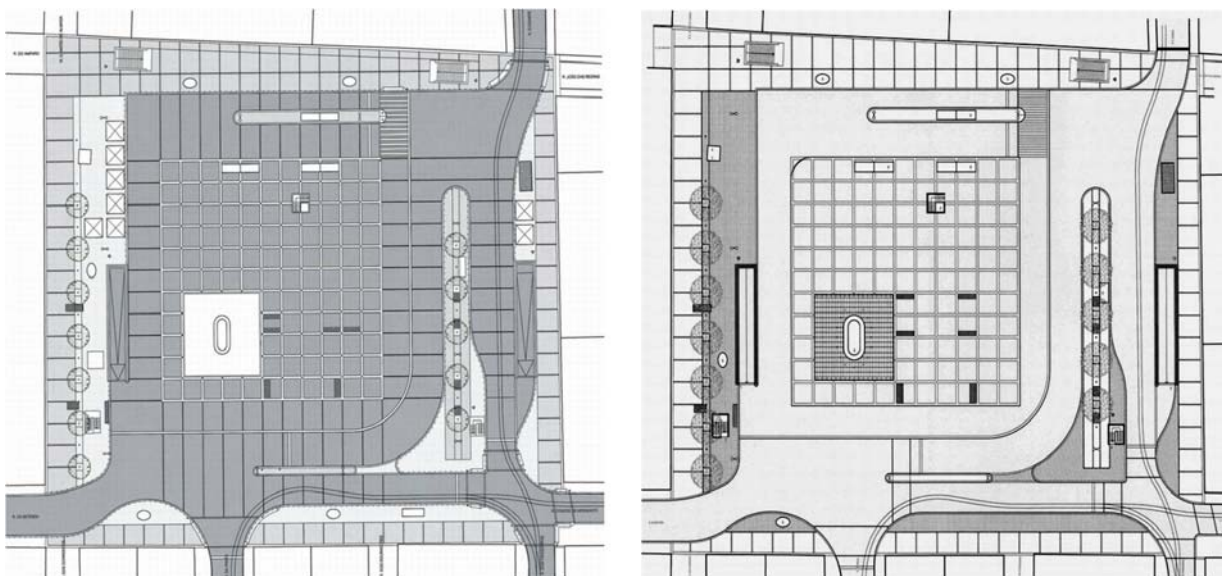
Plantas de síntese, do projecto de execução e das telas finais. É possível observar a proposta de implantação de árvores e da estrutura para comércio e esplanadas no lado oeste ainda existente no projecto de execução (à esquerda). Também é possível perceber a intenção inicial da malha desenhada no chão que regeria o espaço, mas que acabou por ser retirada (Atelier Daciano da Costa, imagens cedida por João Paulo Martins)
